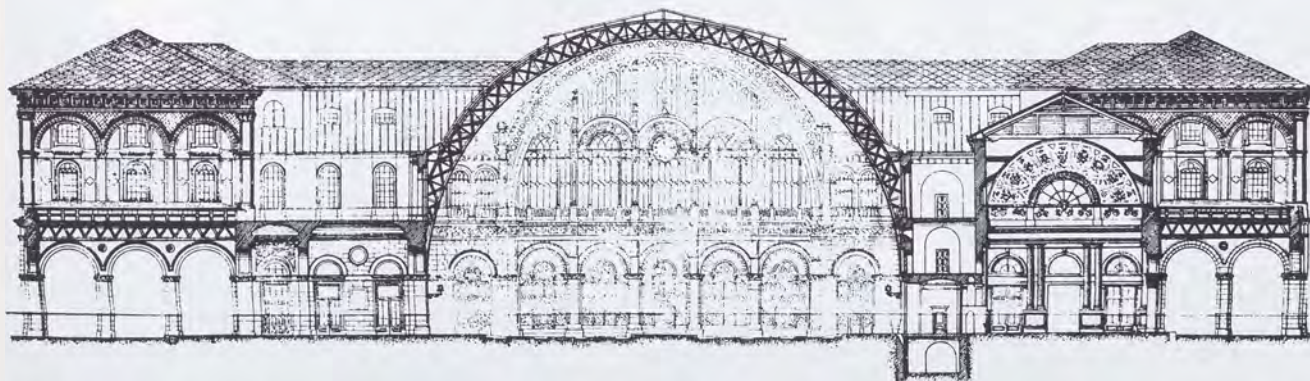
La grande centina della stazione di Porta Nuova, su 48 m di luce, nel progetto di Alessandro Mazzucchetti (1867).
